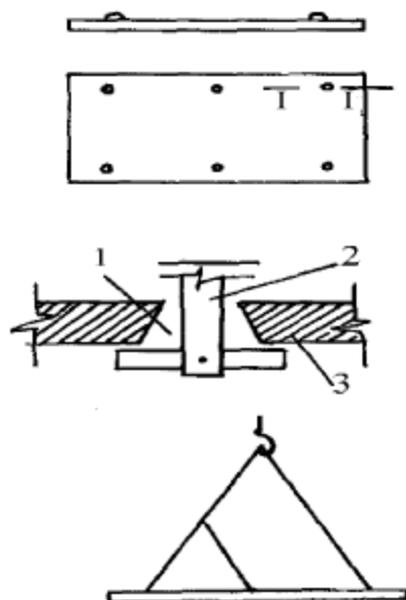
Использование отверстий в панели перекрытия для присоединения к захватному устройству монтажного механизма:
